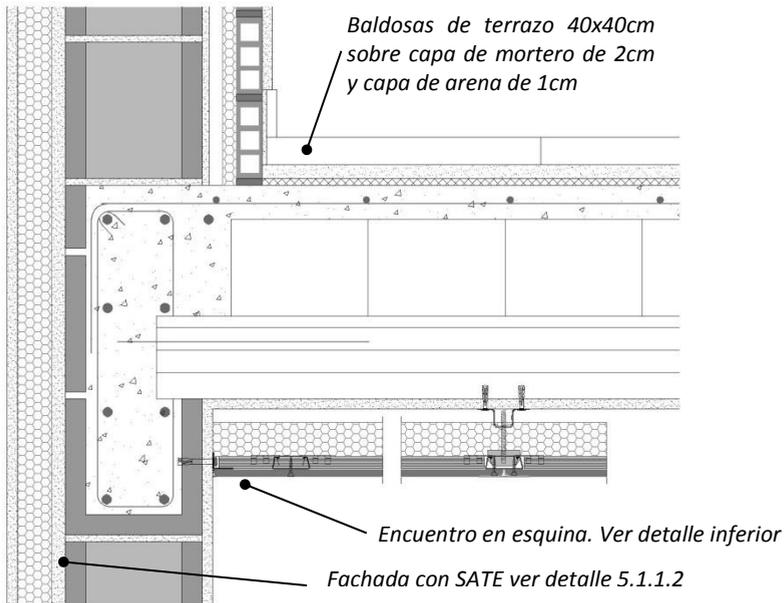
Detalle de cubierta con aislamiento bajo forjado. Fuente propia. Detalle sin escala.
